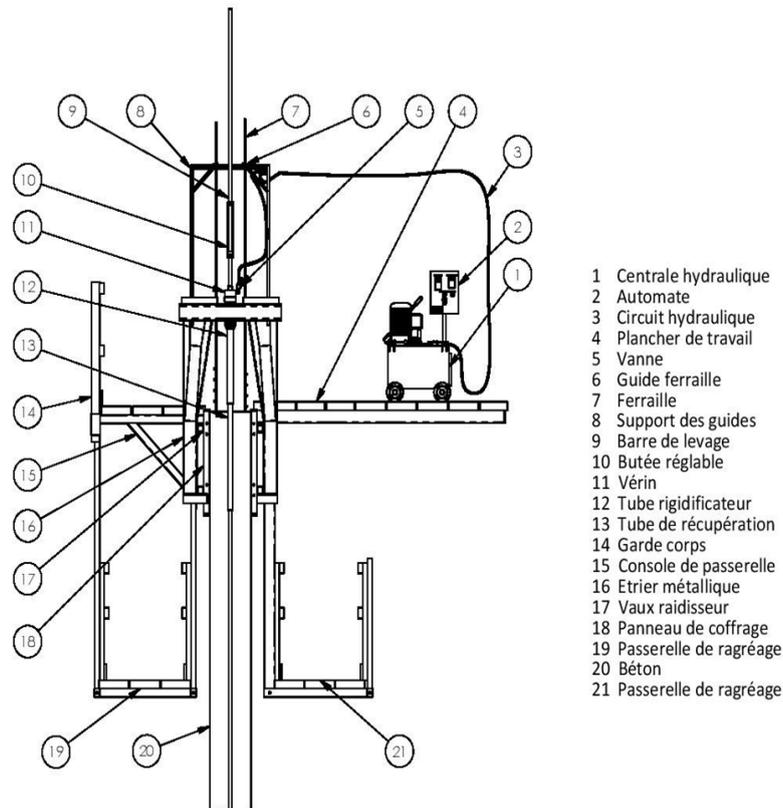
Coupe détaillant les éléments d'un coffrage glissant
